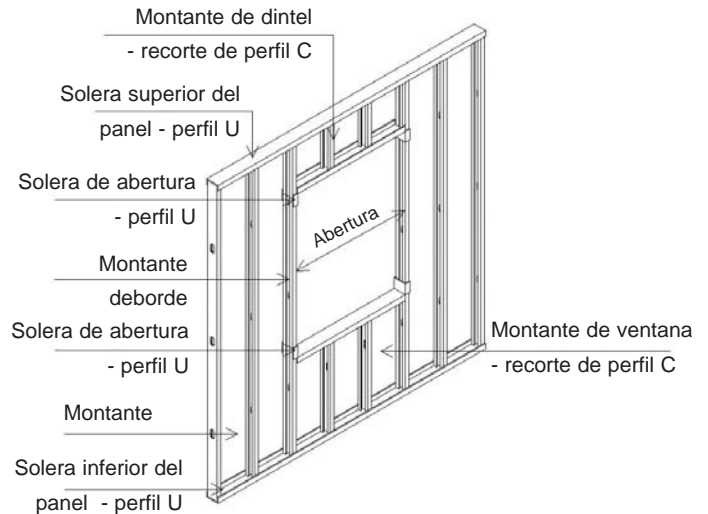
Diseño esquemático de panel no estructural con abertura.
